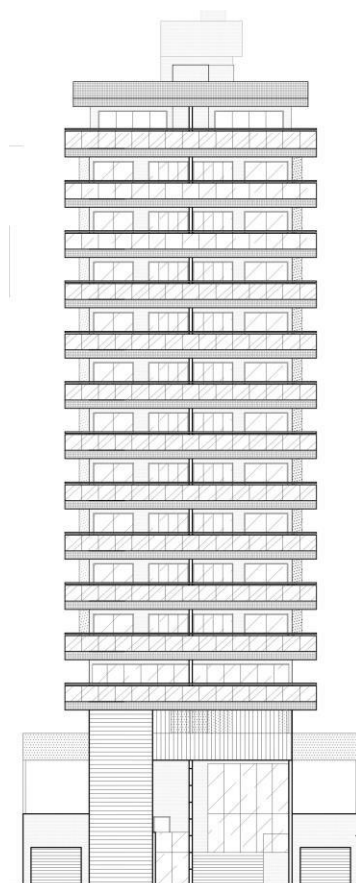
Fachada do prédio para a Rua Joaquim Távora.
